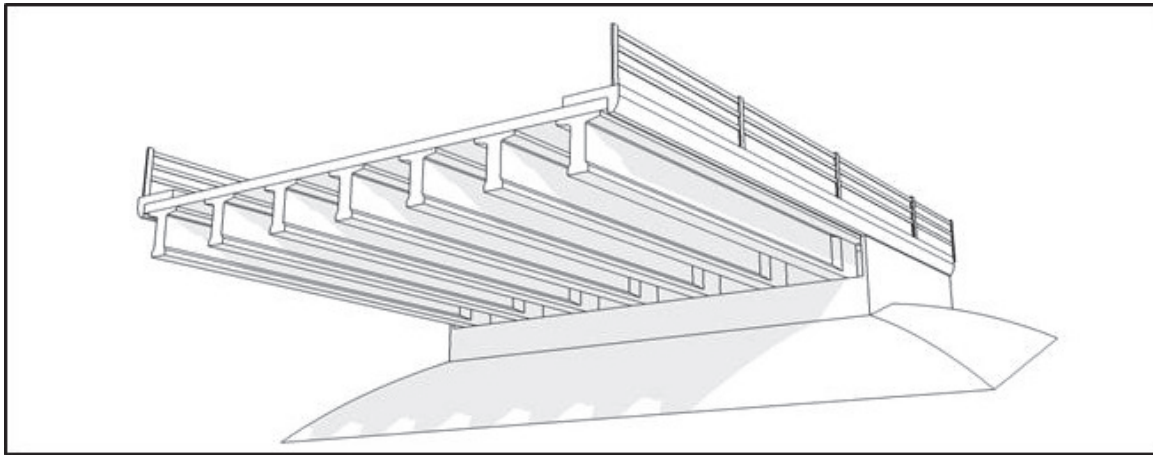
Morphologie générale d'un pont à poutres en béton précontraint.
